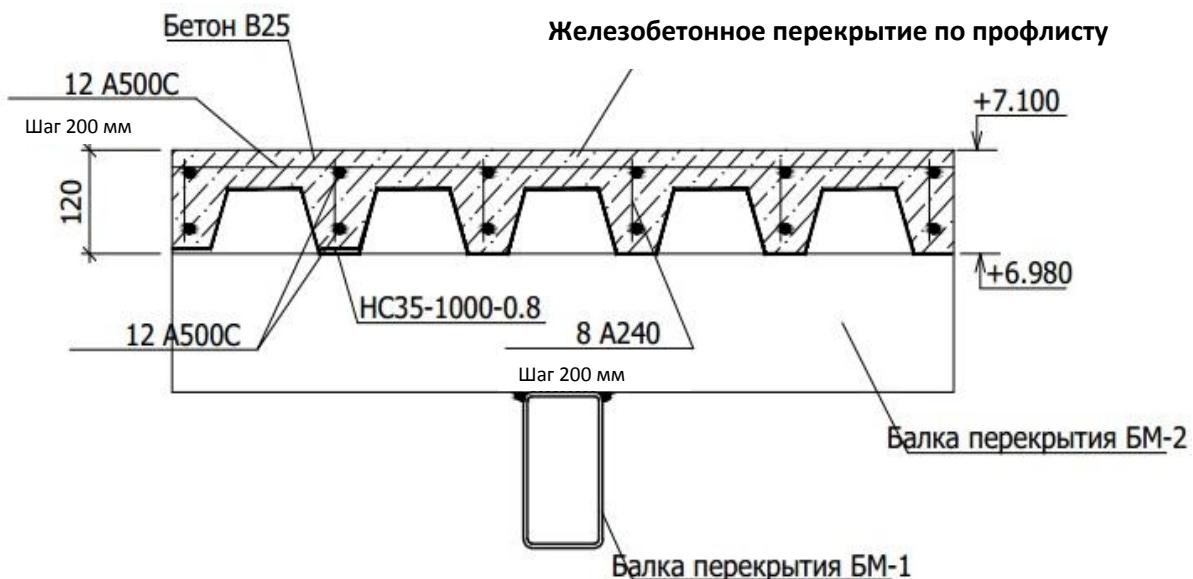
Схема армирования перекрытия с использованием СПН [4]
